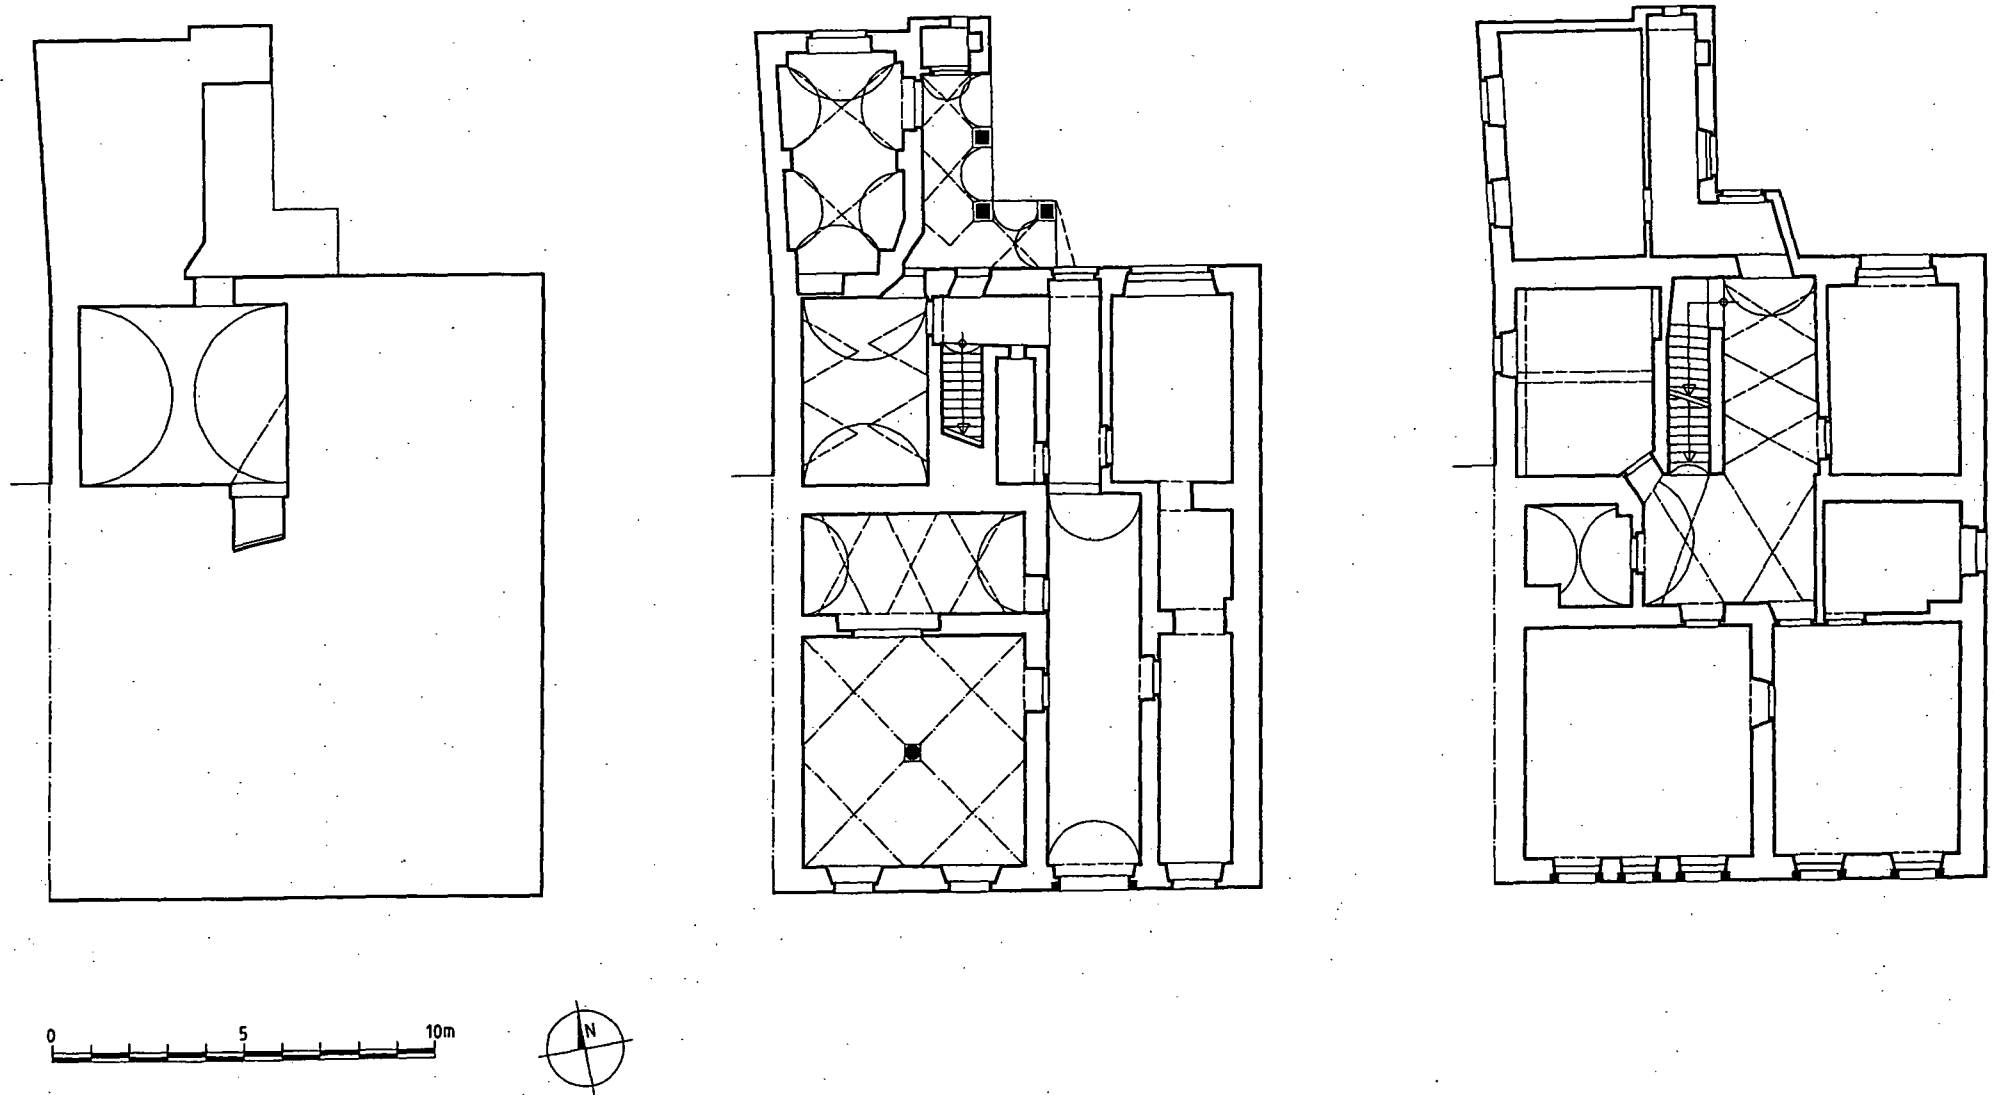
Keplerstraße 2 – Grundrisse Keller, Erdgeschoss, Obergeschoss (1:200).
